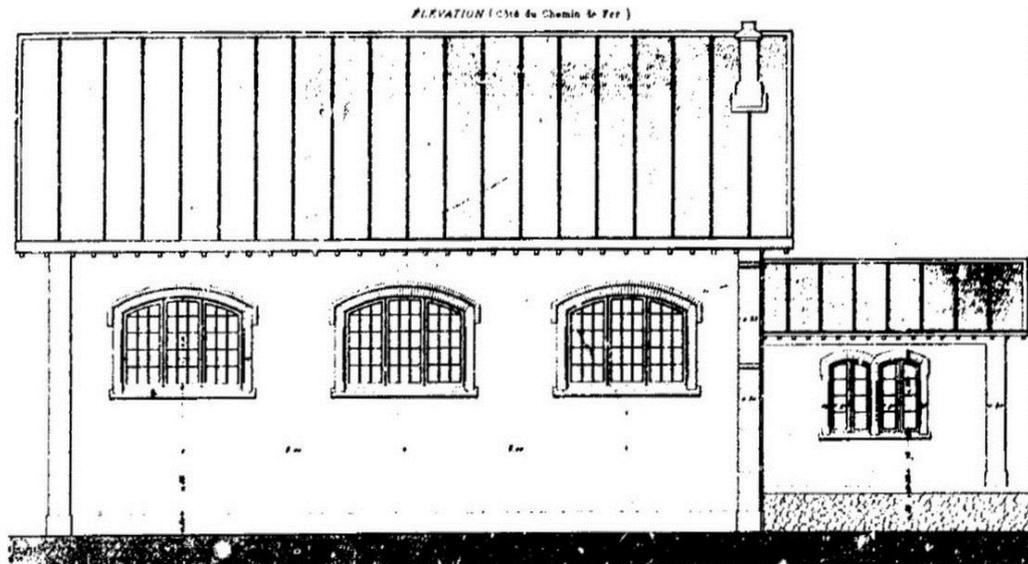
Prospetto longitudinale lato ferrovia della Halle Marchandise de la Gare de St. Amand. Fonte: blog di collezionista privato, Jean-Claude Drion
